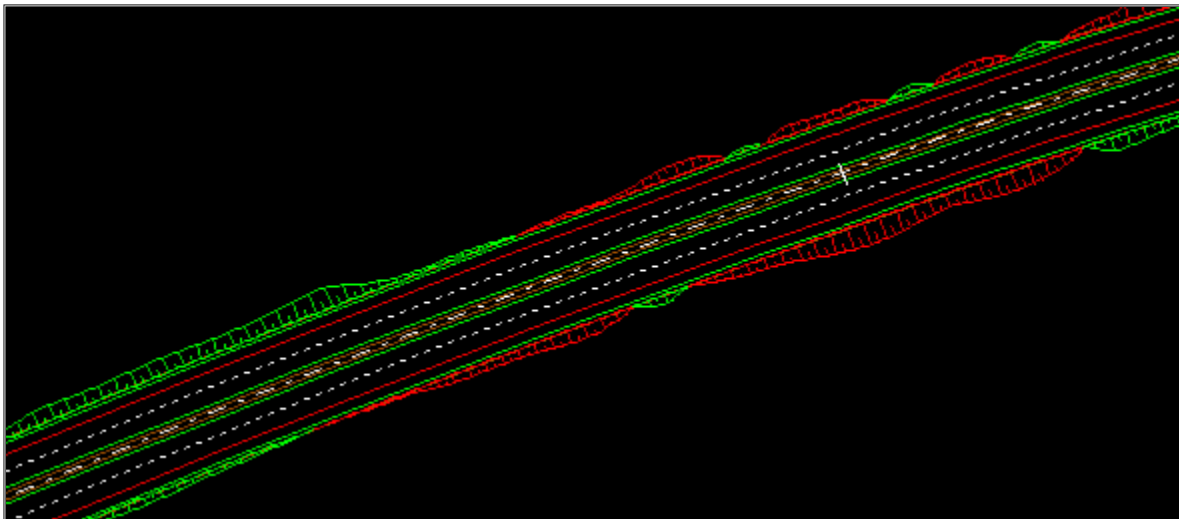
Vista en planta con los definición de anchos y taludes de la autovía.
